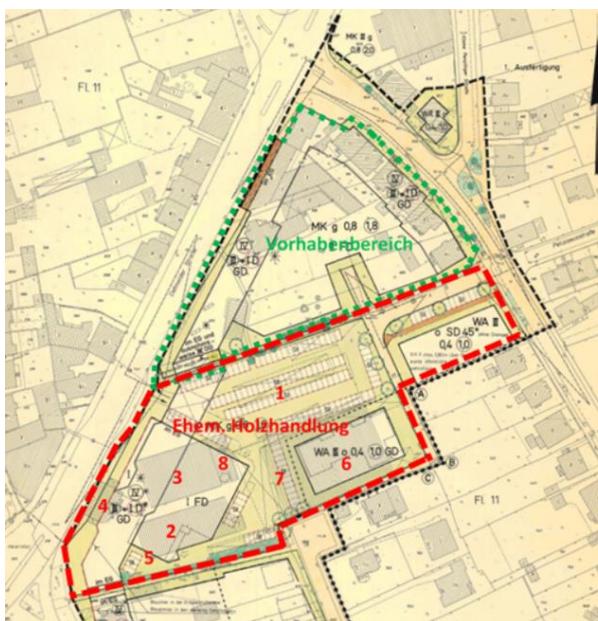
Lageplan Ehemalige Holzhandlung Todt
